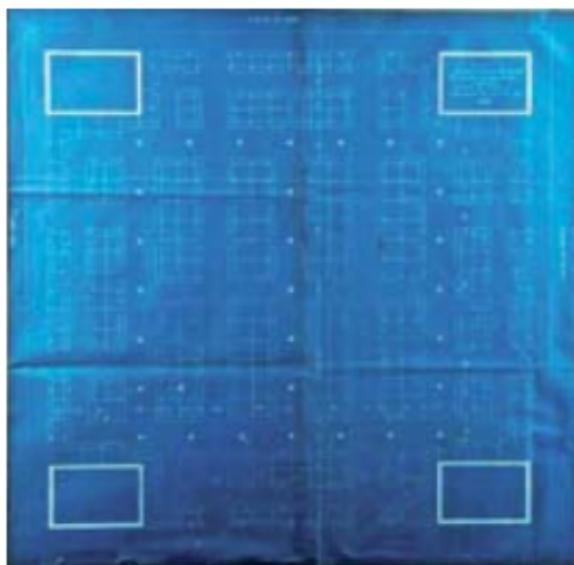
Plan original del mercado Pino Suárez de Mazatlán, 1896. Planta
